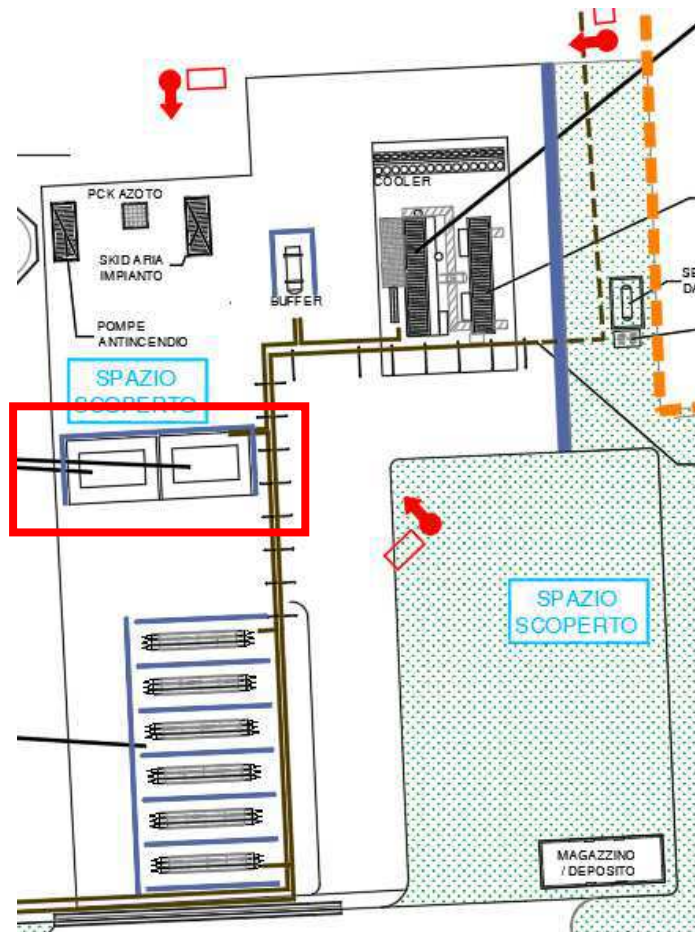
Individuazione planimetrica del box Compressori nel Lotto 1
